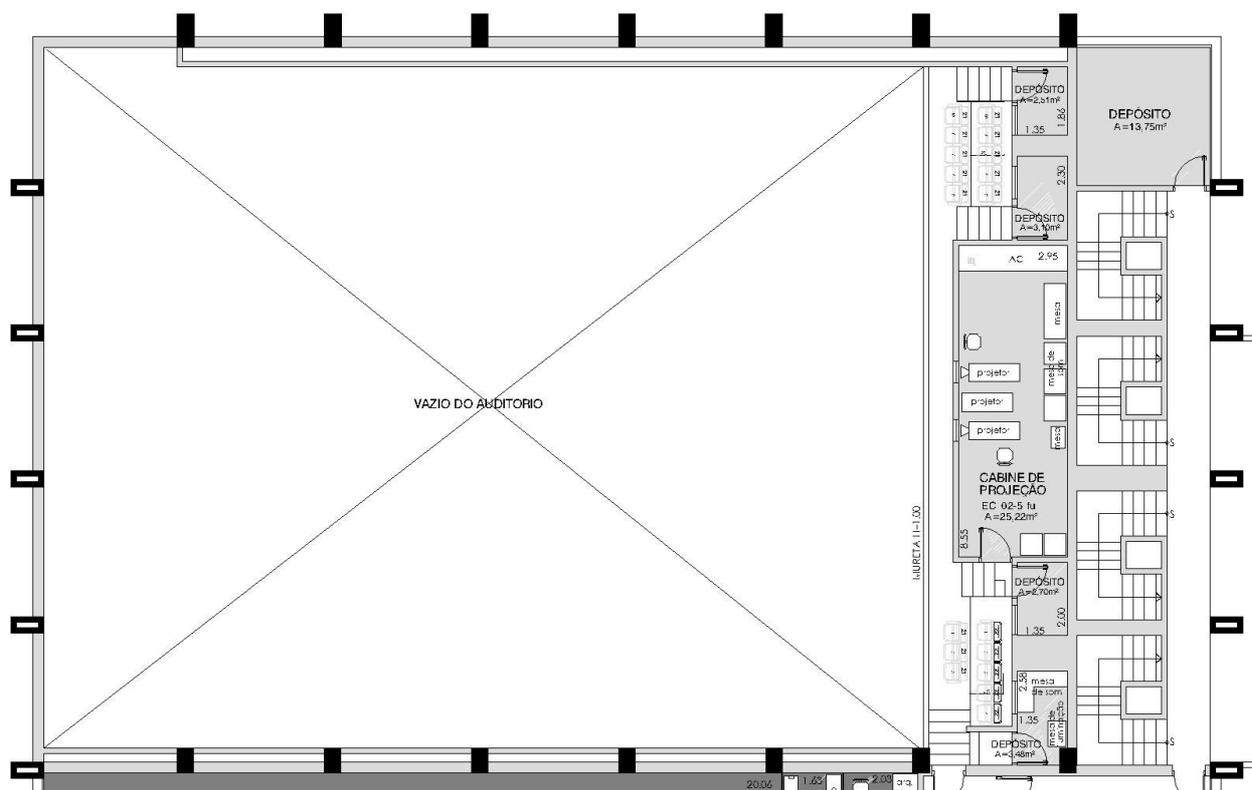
Levantamento Cadastral Arquitetura 2º Andar
